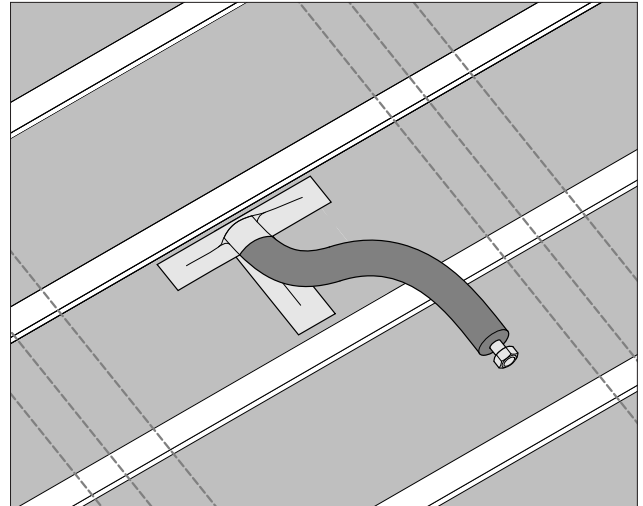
Rohrdurchführung mit Unterspannbahn: Folie T-förmig einschneiden, Anschluss Schlauch durchführen und Schnittflächen mit geeignetem Klebeband verkleben.
